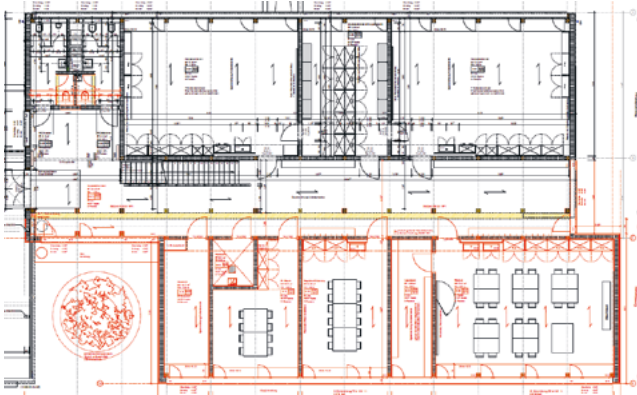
Grundriss Erdgeschoss (Planstand TU-Ausschreibung)
